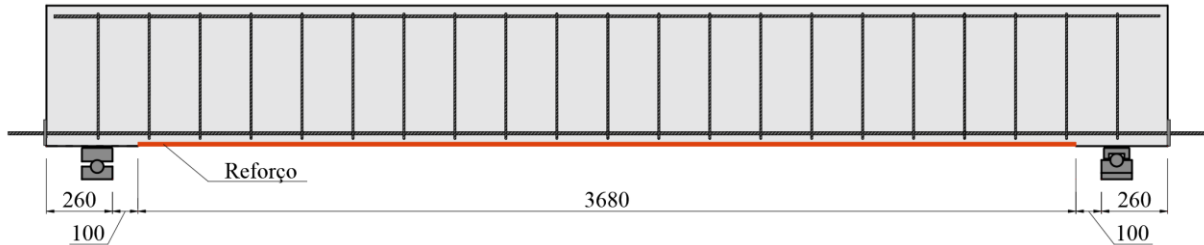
Detalhamento do reforço das vigas ensaiadas.
